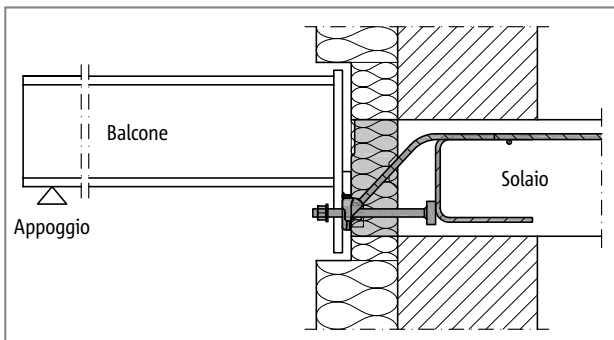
Schöck Isokorb® T tipo SQP: punto di passaggio privo di barriere mediante salto di quota
